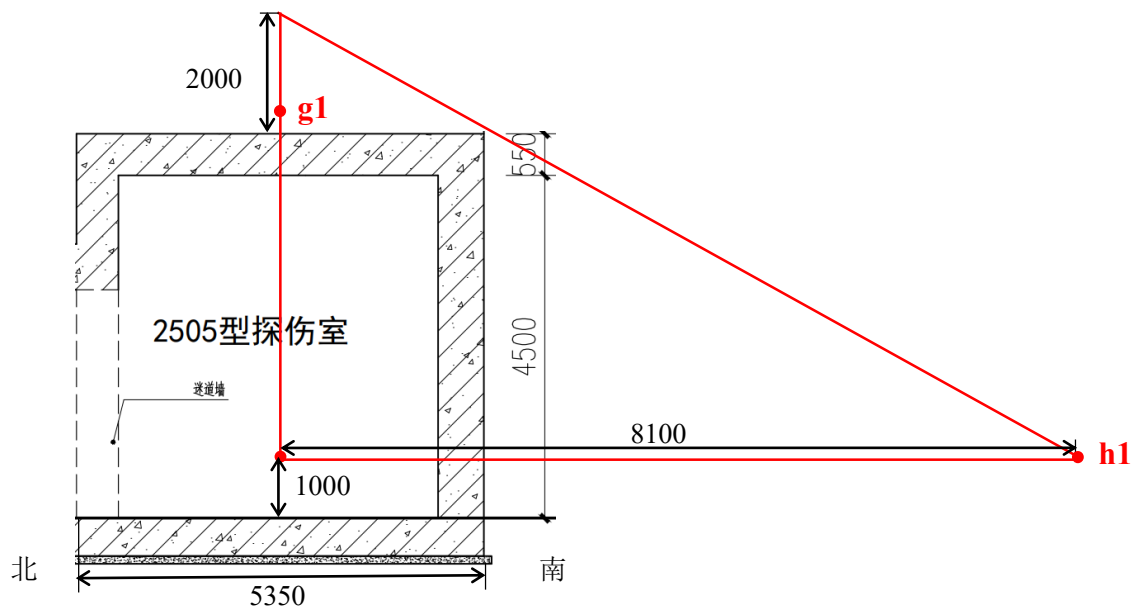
1号探伤室辐射屏蔽计算预测点位剖面图 (单位: mm)
